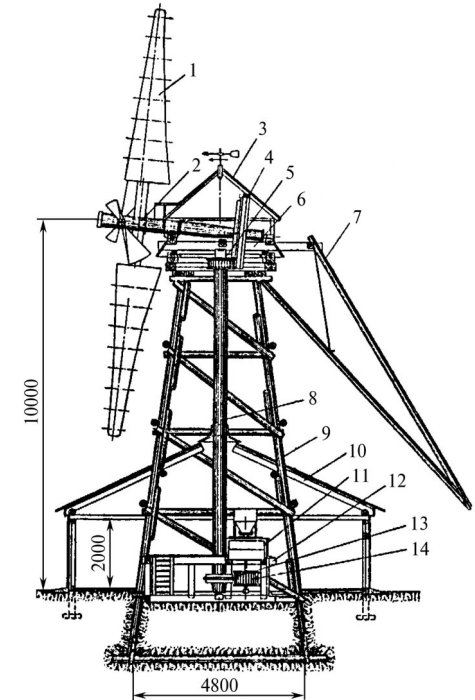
Вітряний млин: 1 – вітроколесо; 2 – головний вал; 3 – шатро; 4 – ведуче колесо; 5 – цівочна шестерня; 6 – рама шатра; 7 – водило; 8 – вертикальний вал; 9 – башта; 10 – будівля млина; 11 – жорно; 12 – рама підставки; 13 – ведуче колесо нижньої передачі; 14 – цівочна шестерня.
